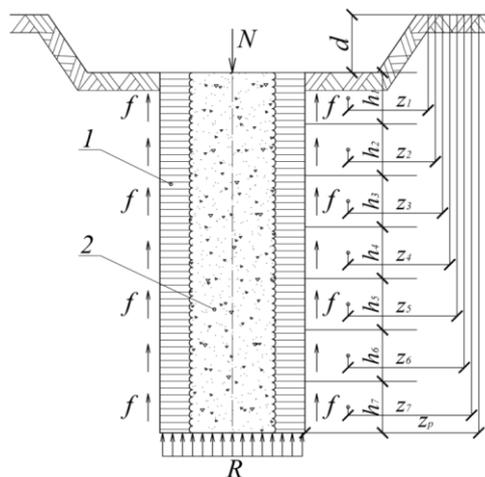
Схема к определению несущей способности сваи SFA (НПШ) совместно с грунтоцементным массивом по грунту (грунтобетонные сваи (ГБС): 1 – грунтоцементный массив, 2 – свая SFA (НПШ)
